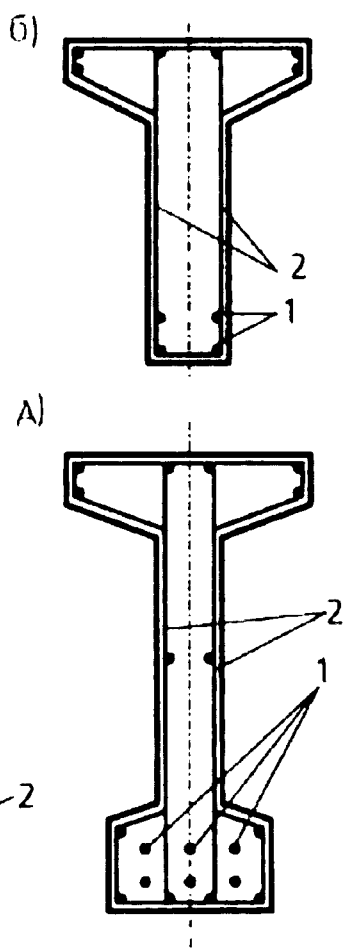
Формы поперечного сечения балок и схемы армирования:
